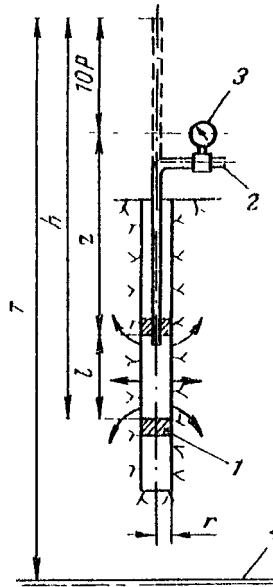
Схема проведения опыта по нагнетанию в неводонасыщенный грунт:
